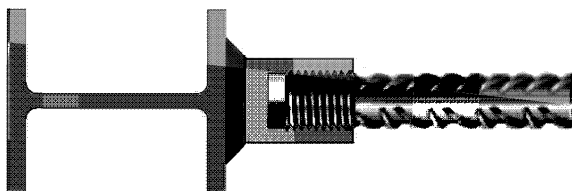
Привариваемое резьбовое соединение арматуры
